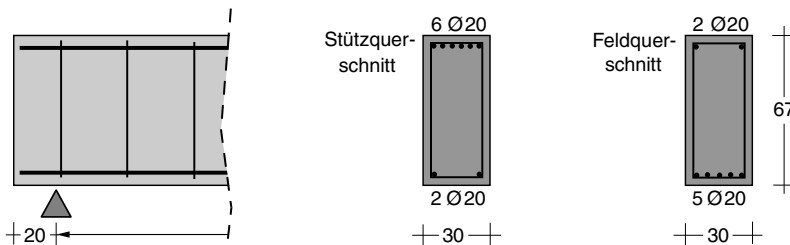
Bewehrungskonstruktion am Durchlaufträger/Details
